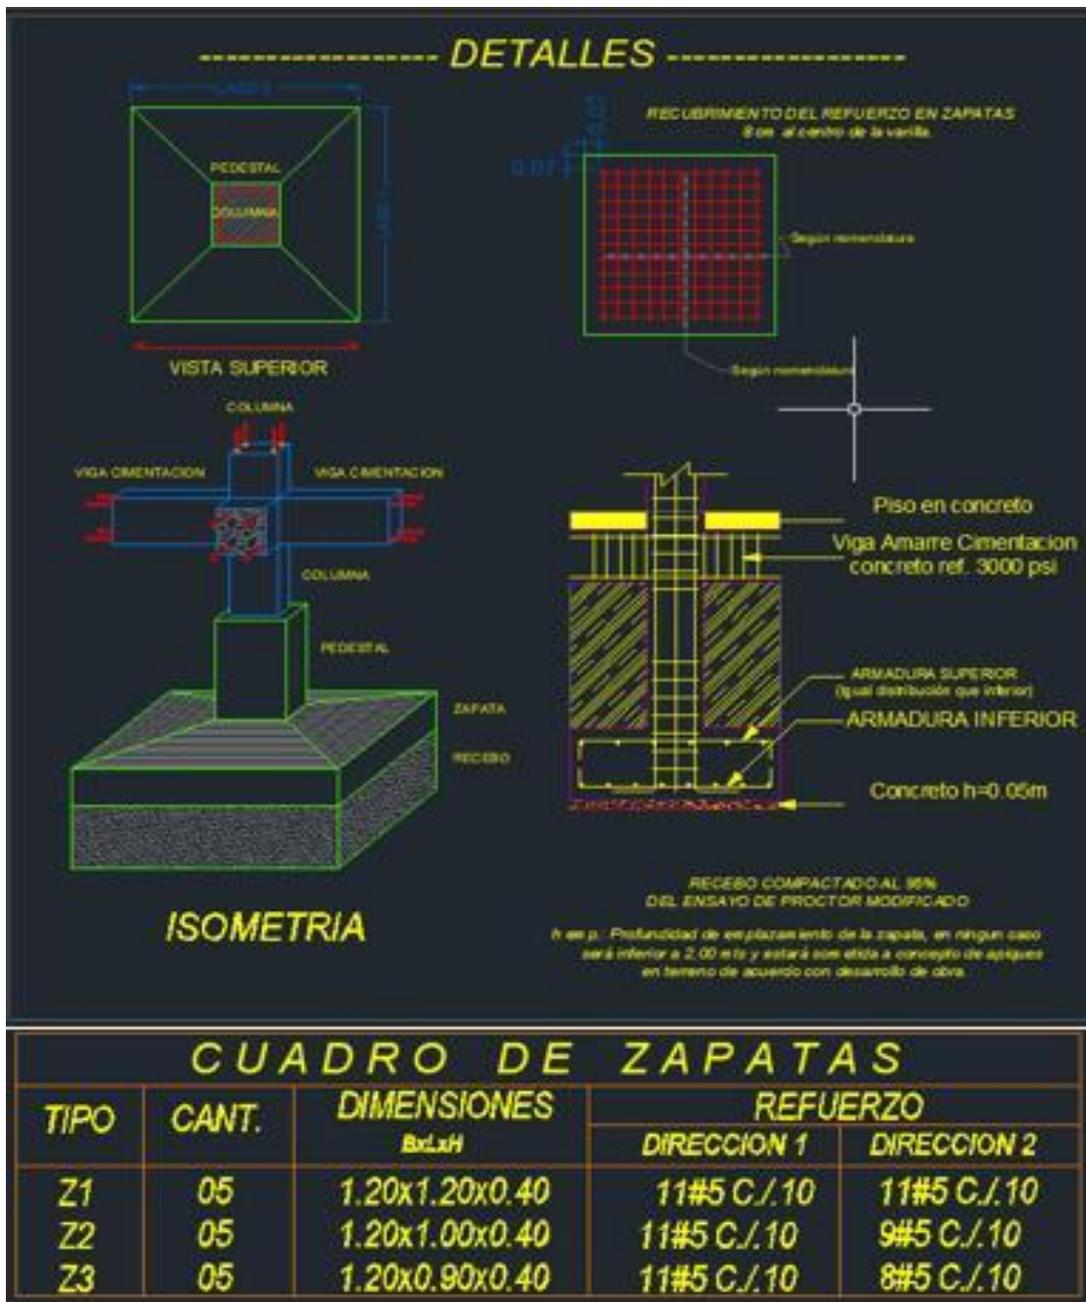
Detalles de aspectos como la zapata, viga y columnas adyacentes
